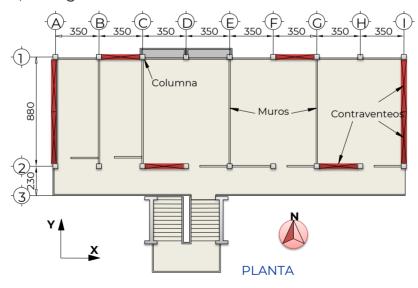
Ejemplo de croquis planta tipo de un edificio
